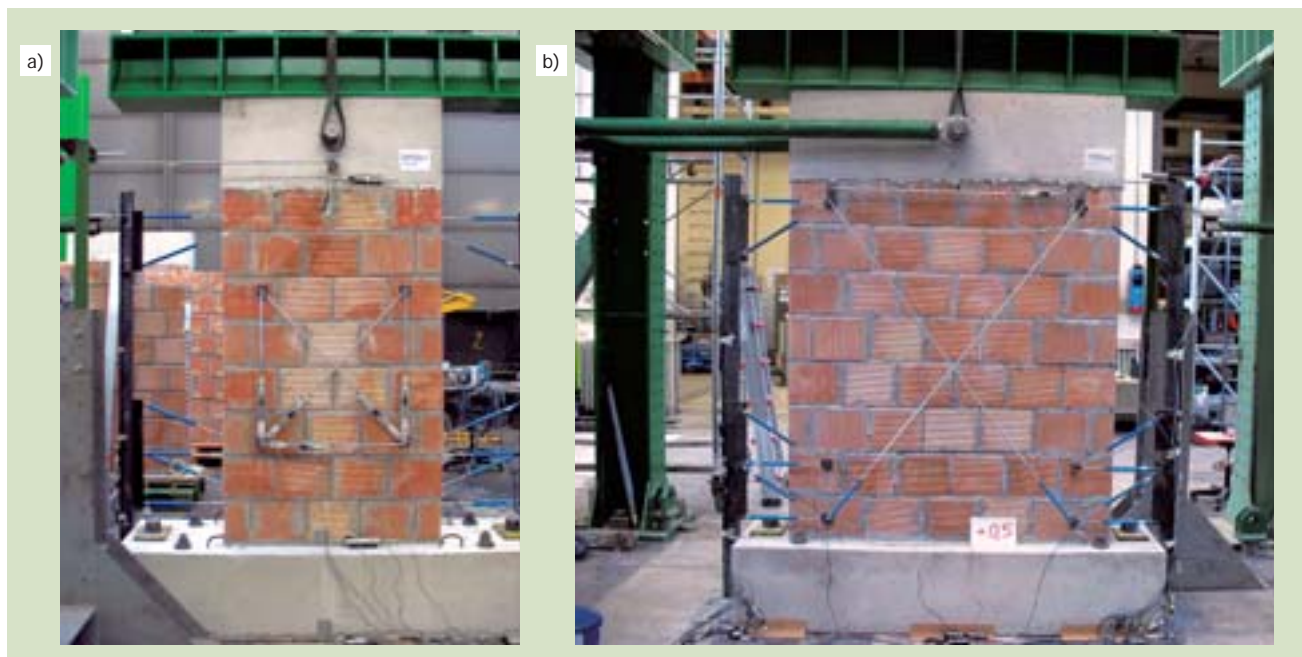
Sistema di muratura armata Alan Metauro: a) prova di compressione uniassiale su muretto da 1030 x 1085 x 300 mm senza colonne di confinamento; b) prova ciclica di compressione e taglio su muretto da 1550 x 1710 x 300 mm con colonne di confinamento.
